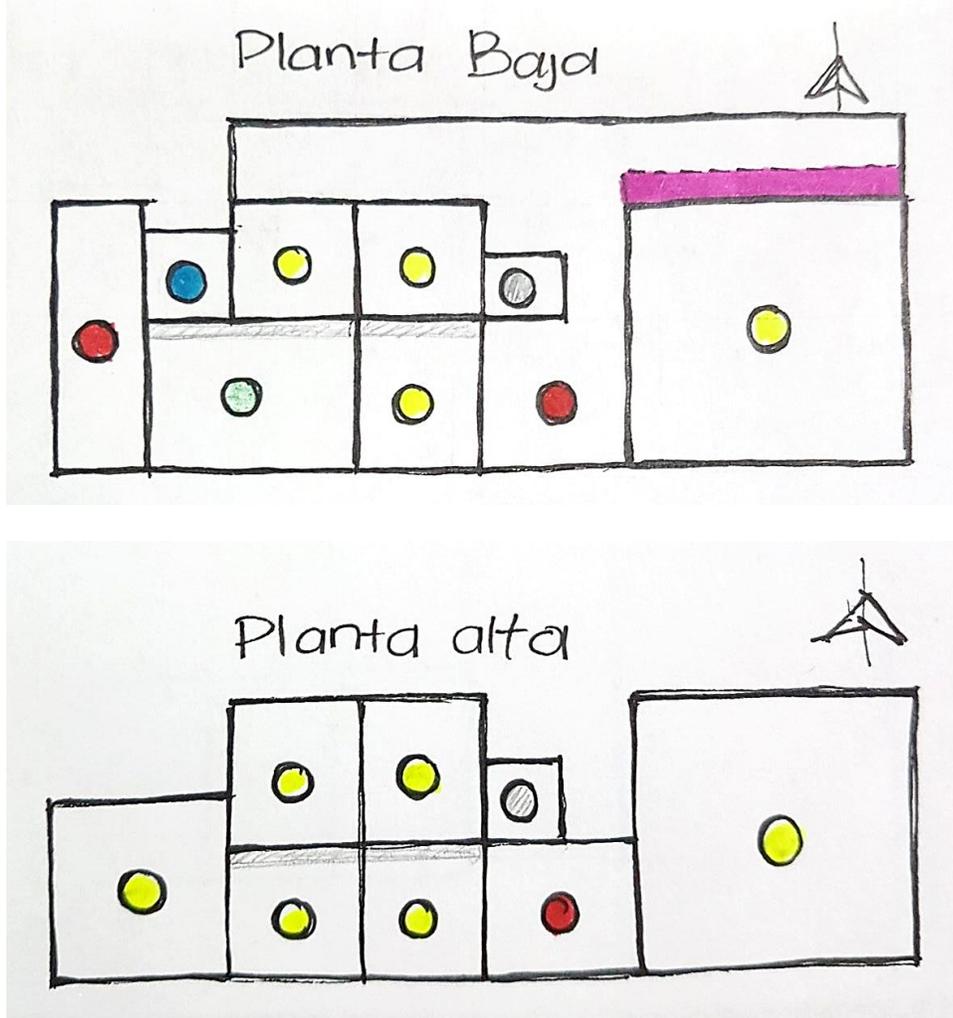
Zonificación planta baja y alta. Fuente: Archivo personal M. García.
